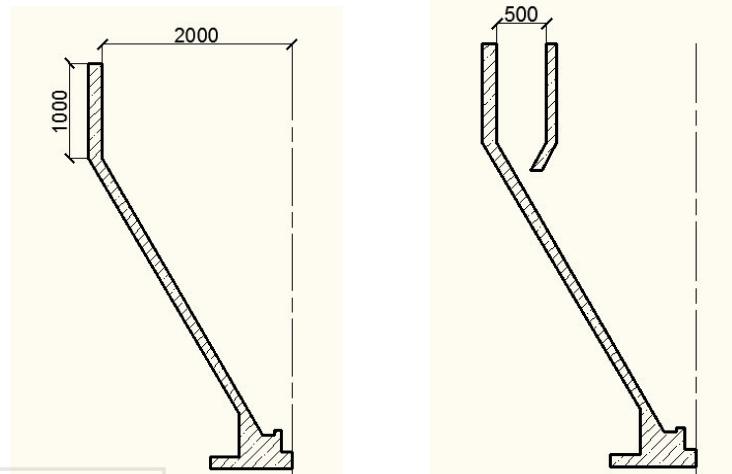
Базис для формування корпусу споруди і кільцевого жолобу
